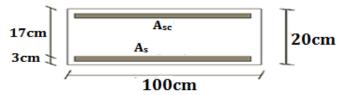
Dimensions de la section transversale du voile périphérique Tableau.VI.14 : Ferraillage en appui et en travée du voile périphérique à l'ELU et à l'ELS
